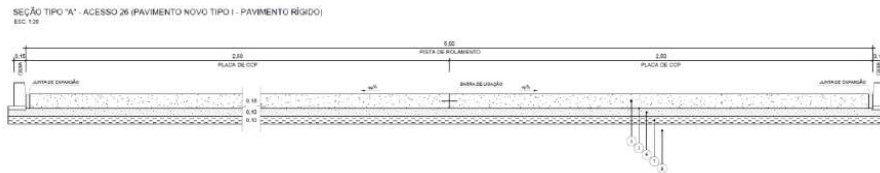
Seção Típica Acesso 26 cota Est. 100 até 104 em pavimento rígido.
